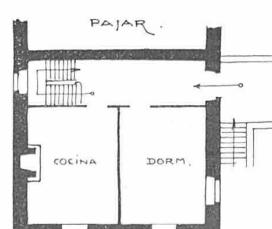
und 2. Grundrisse zum Haus Tafel 14 oben.
